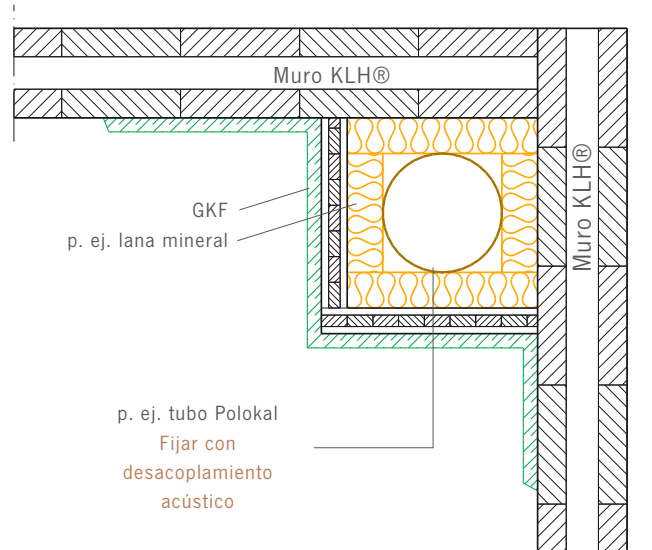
Esquema de funcionamiento de tuberías bajantes en el hueco de instalación - Planta
